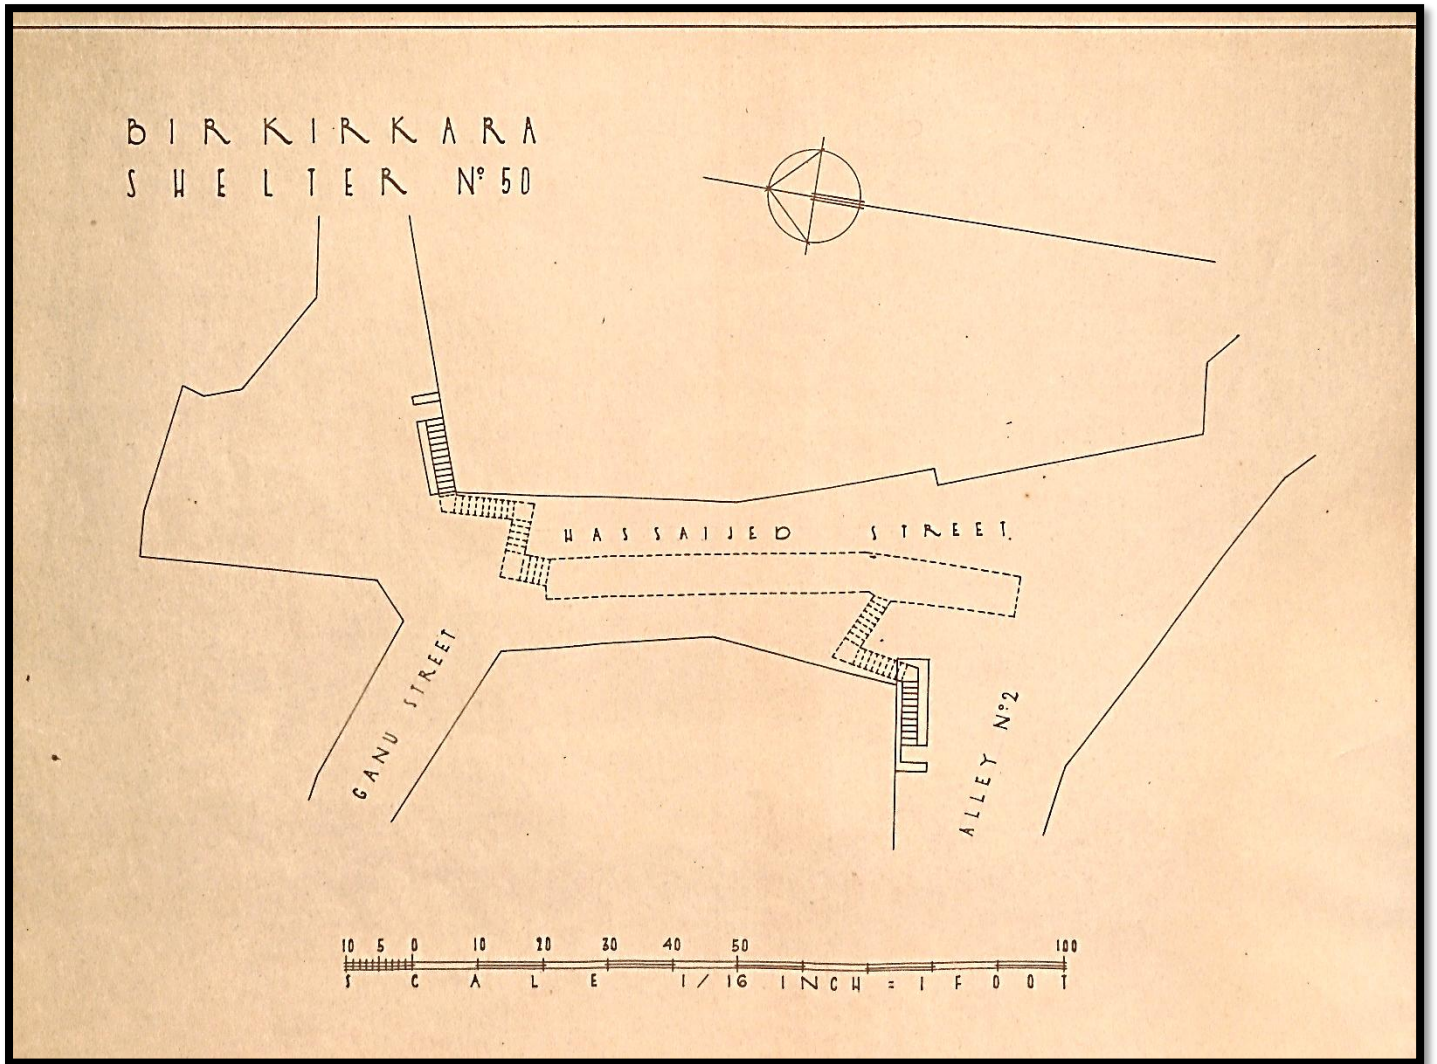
Planta do Abrigo nº 50 "Ganu Street – Hassajjeo Street – Alley nº2."
